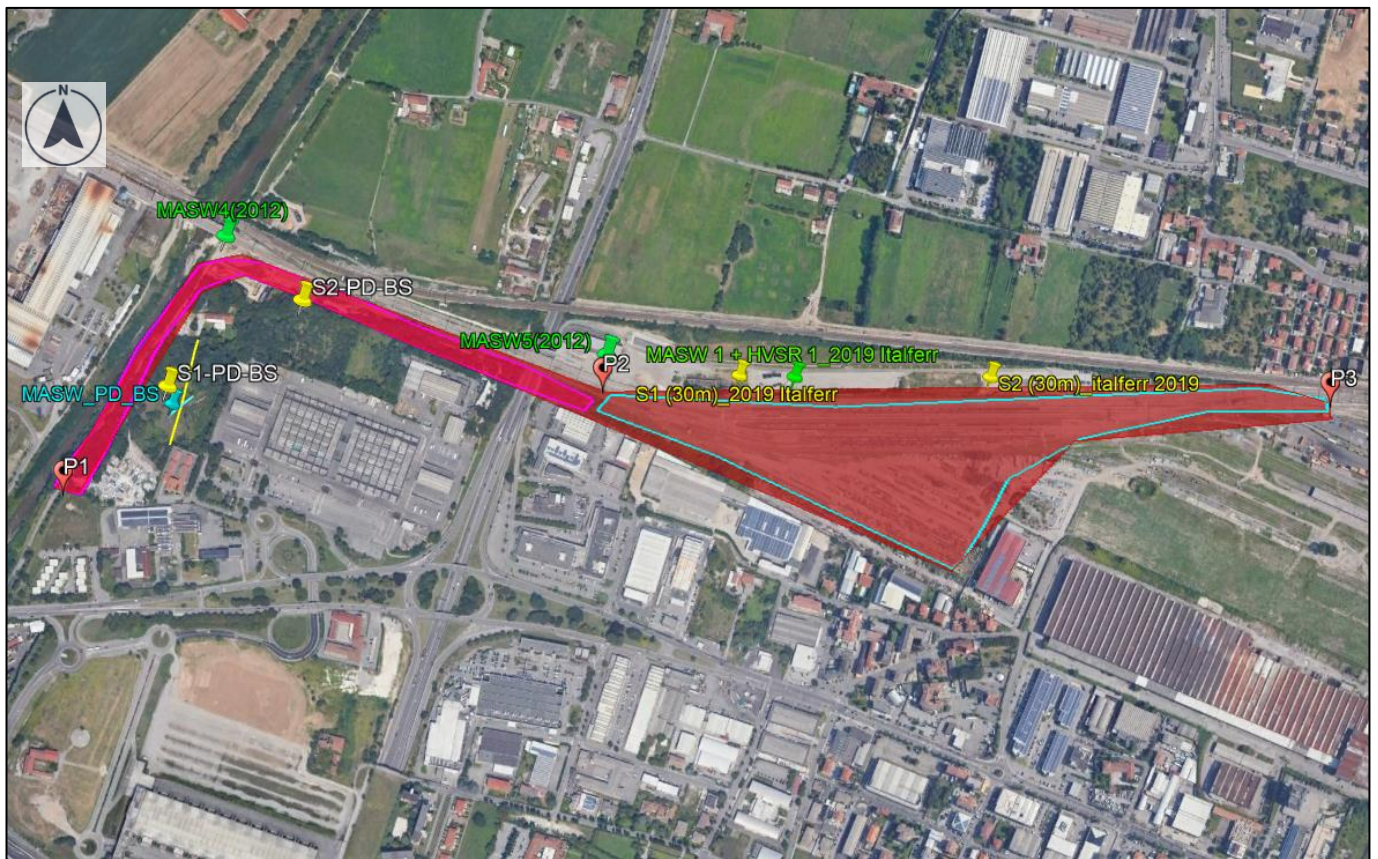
Planimetria delle opere in progetto (area in rosso) con la localizzazione delle indagini di interesse.
